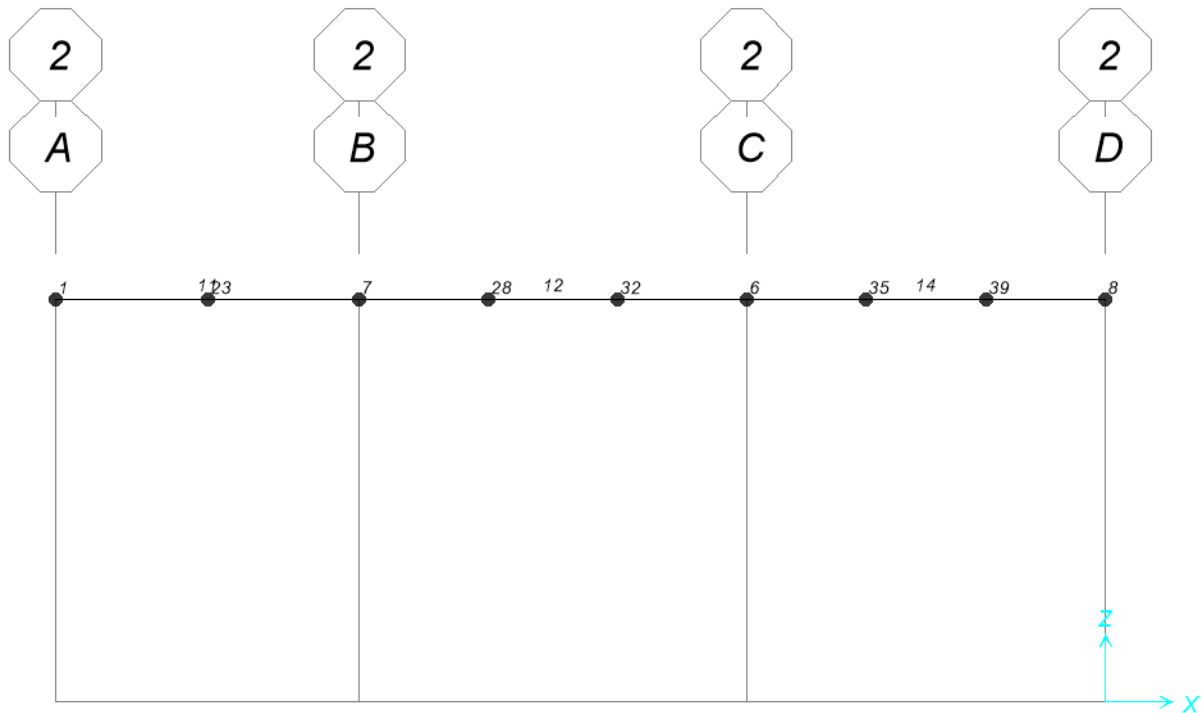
Vista in sezione modello struttura in elevazione –Filo 2 - numerazione elementi frame e joint
